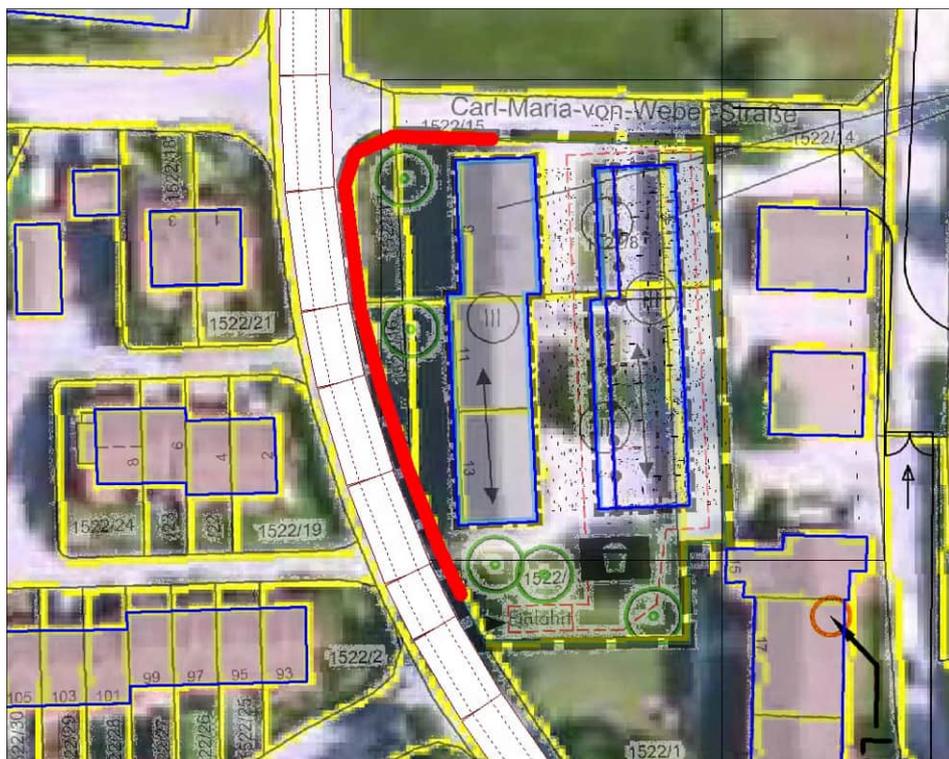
Lageplanskizze mit Darstellung des prinzipiellen Verlaufs einer schalltechnisch wirksamen Grundstückseinfriedung $H=2$ m, $L=80$ m (rote Markierung)
